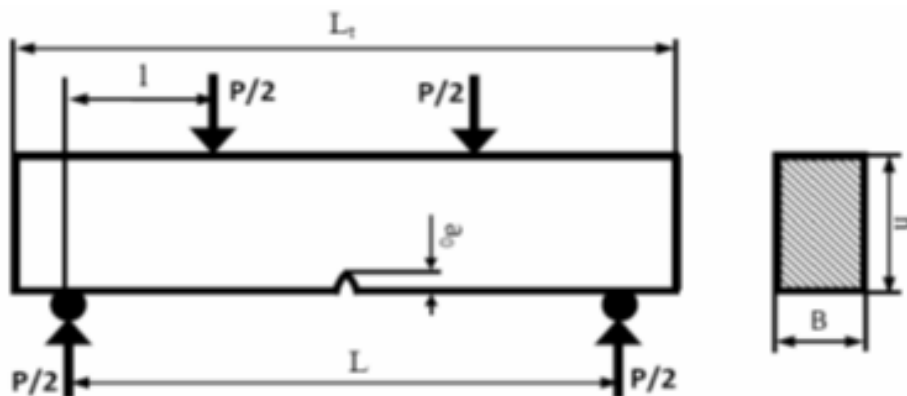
Assemblage schématique et dimensions de l'éprouvette
